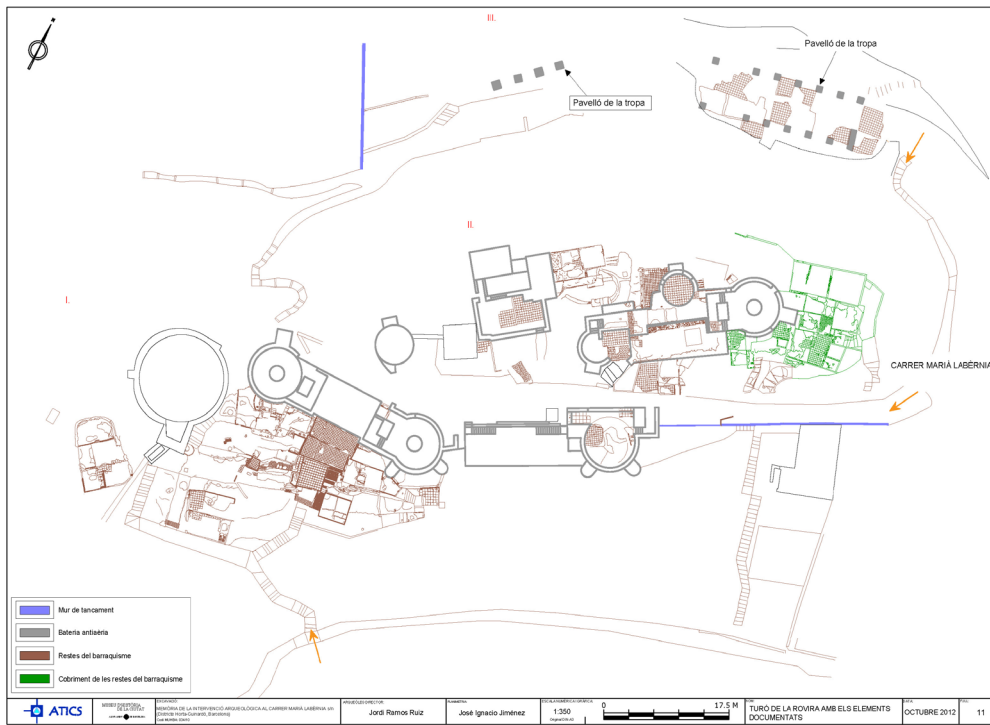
Planta general de la excavación de la fase barraquista en el Turó de la Rovira.
